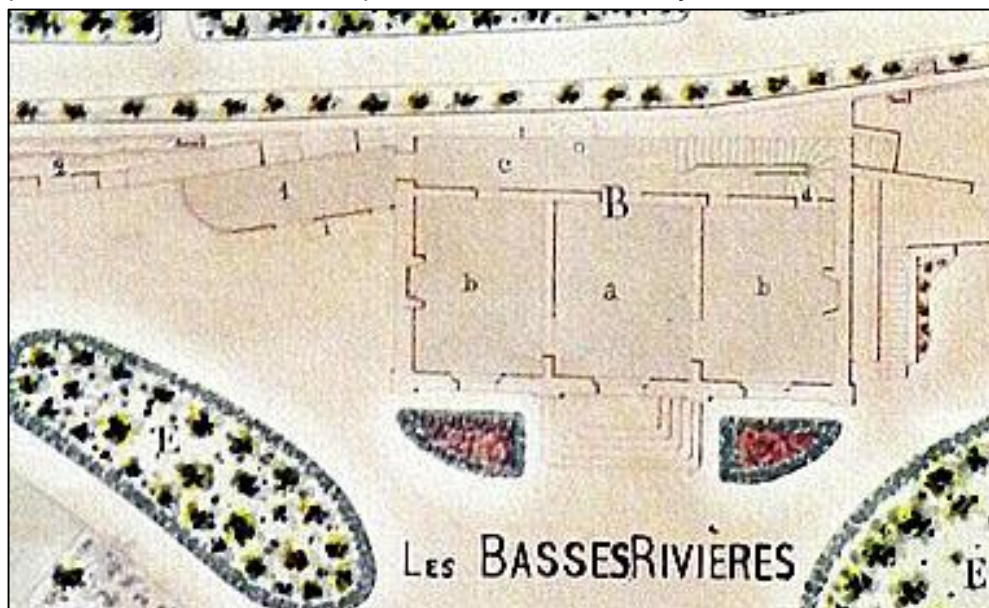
Plan du rez-de-chaussée, tel qu'il devait être en 1844
